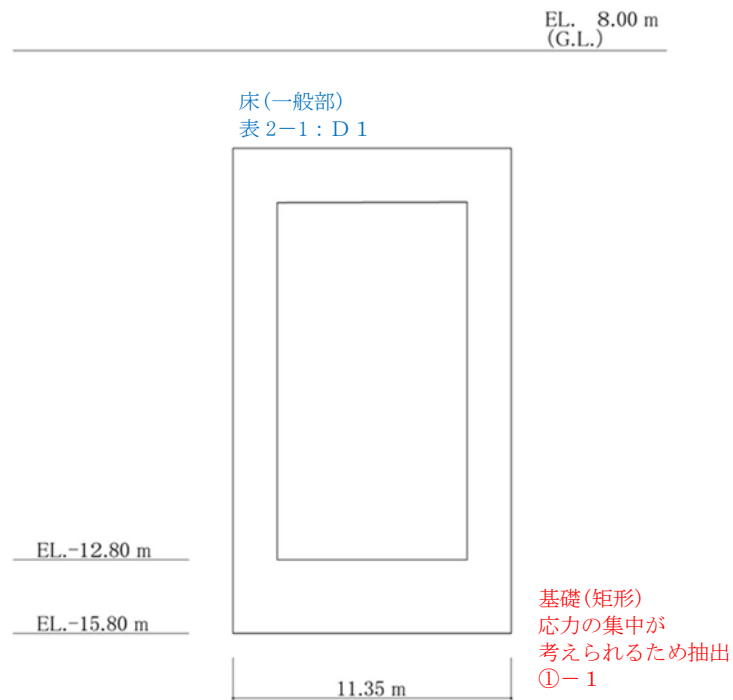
格納容器圧力逃がし装置格納槽の概略断面図 (EW 方向, B-B 断面)
